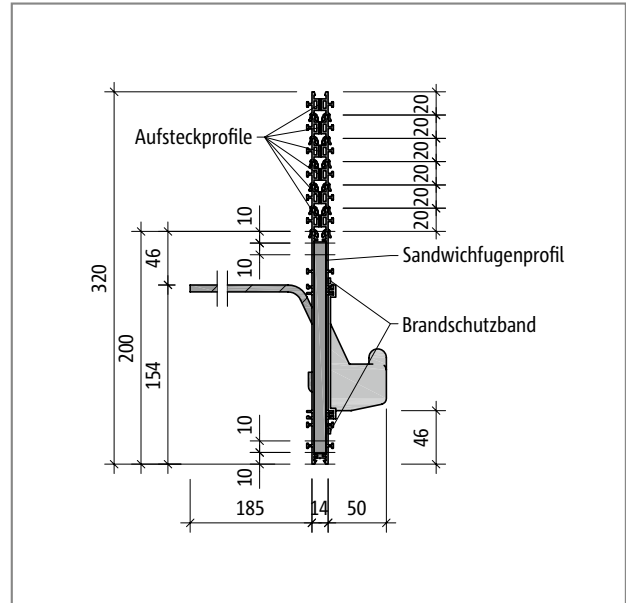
Schöck Tronsole® Typ T: Produktschnitt mit Sandwichfugenprofil und Aufsteckprofilen
